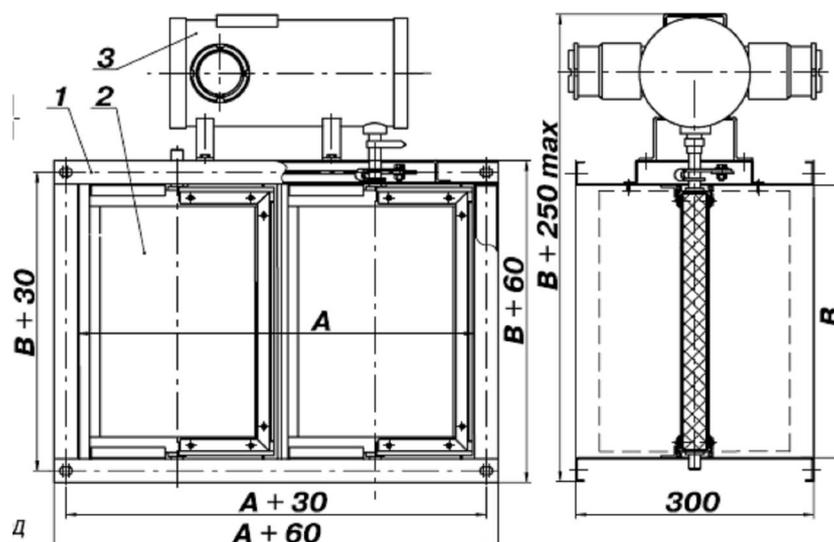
Прямоугольный клапан во взрывозащищенном исполнении: 1 – корпус; 2 – лопатка; 3 – электропривод
